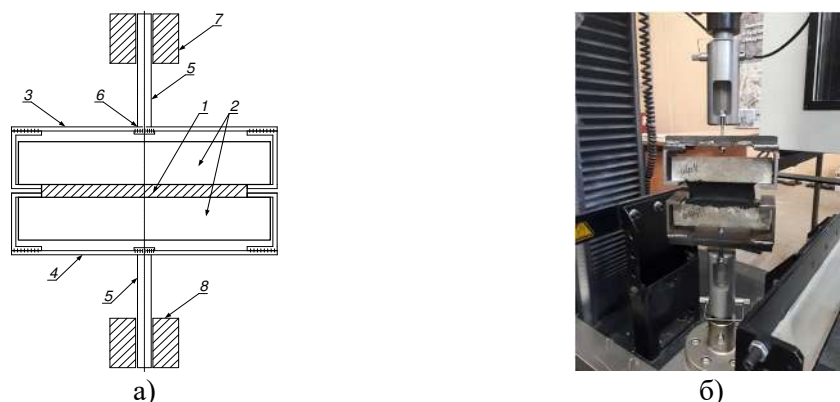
Схема устройства захватов образца деформационного шва для испытаний герметиков (а) и вид испытанного образца (б):
